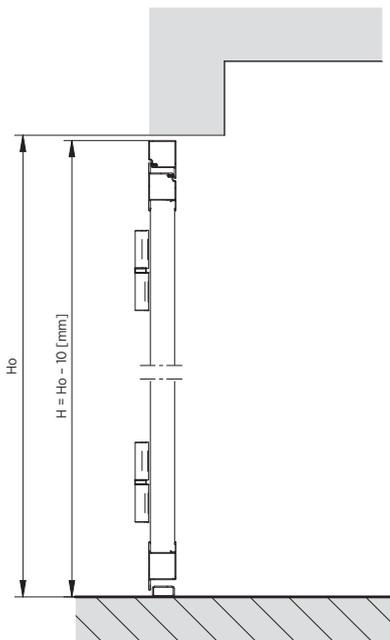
Pose dans la baie - coupe verticale - Porte battante à deux vantaux Presto 50
